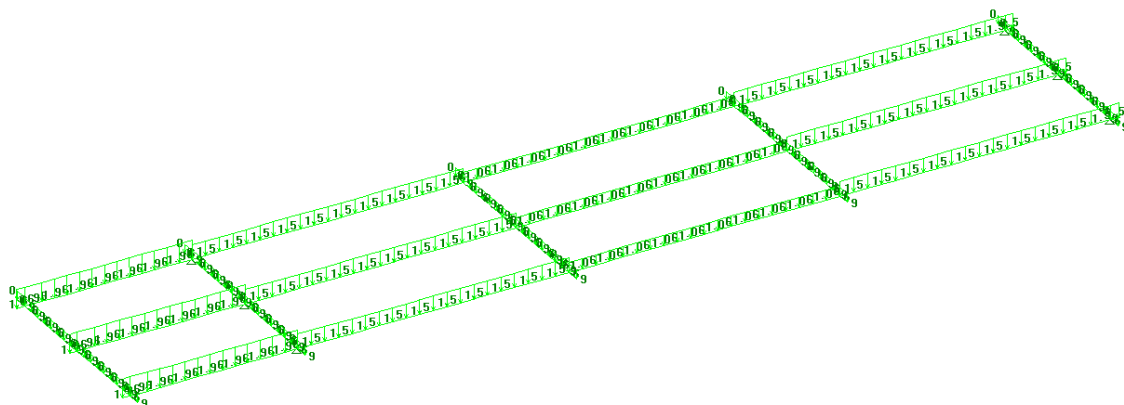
PP vigas + transversinas vão 1 (entrada)
